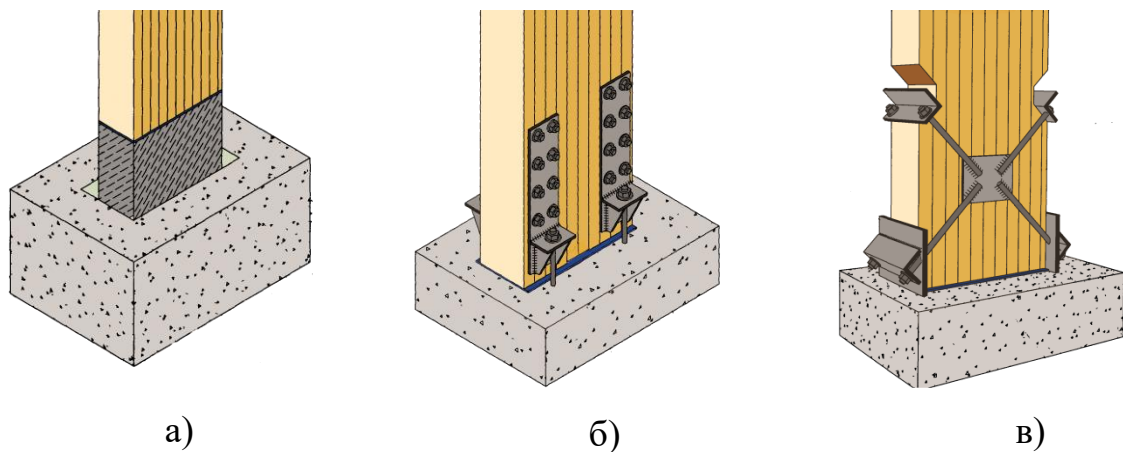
Варианты решения узла заземления колонн в фундаментах а) - с использованием железобетонного элемента, прикрепляемого к колонне на клеенных стержнях; б) - с применением стальных траверс, прикрепляемых к колонне болтами; в) - с использованием перекрестных тяжей
